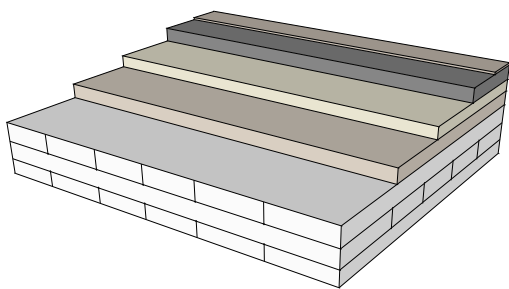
Konstruktionsschema Brettsperrholzdecke
